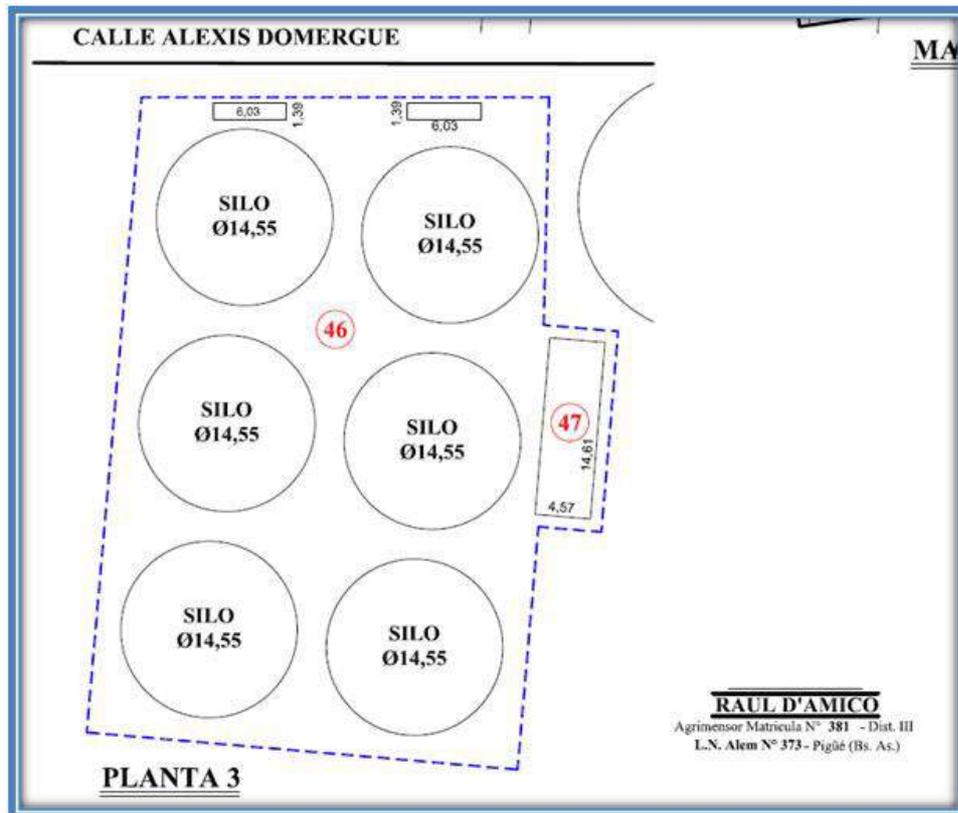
Planta de Silo 3 (Ref. n° 46) y caseta de descarga (Ref. n° 47)
